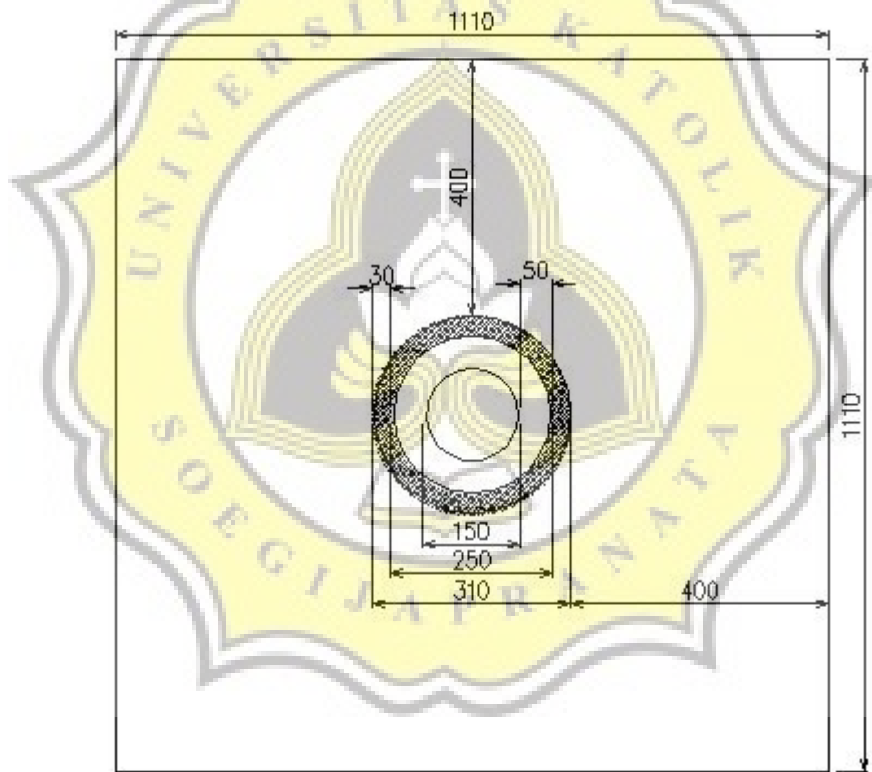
Denah Layout Ruang Simulasi Indoor
